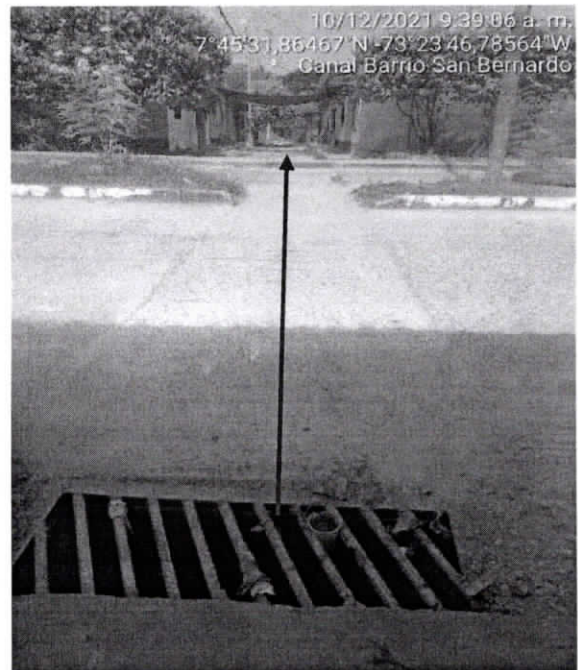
Alcantarillado Pluvial Diagonal 2c entre carrera 8 y 7a del barrio San Bernardo.
